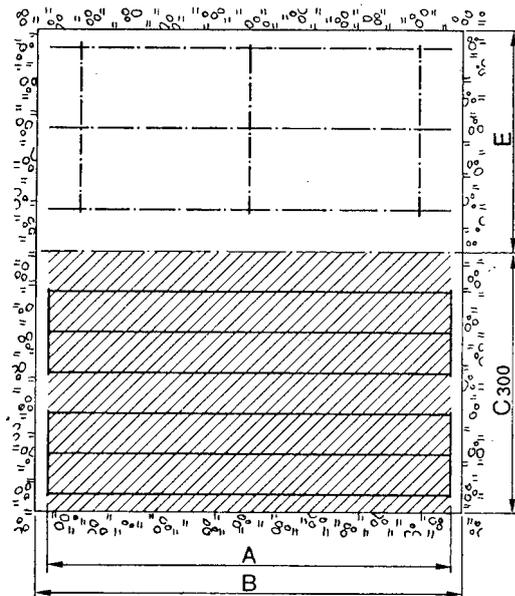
Beheizte Decke mit Rohrabständen von 300 mm. E = unbeheizter Deckenteil
